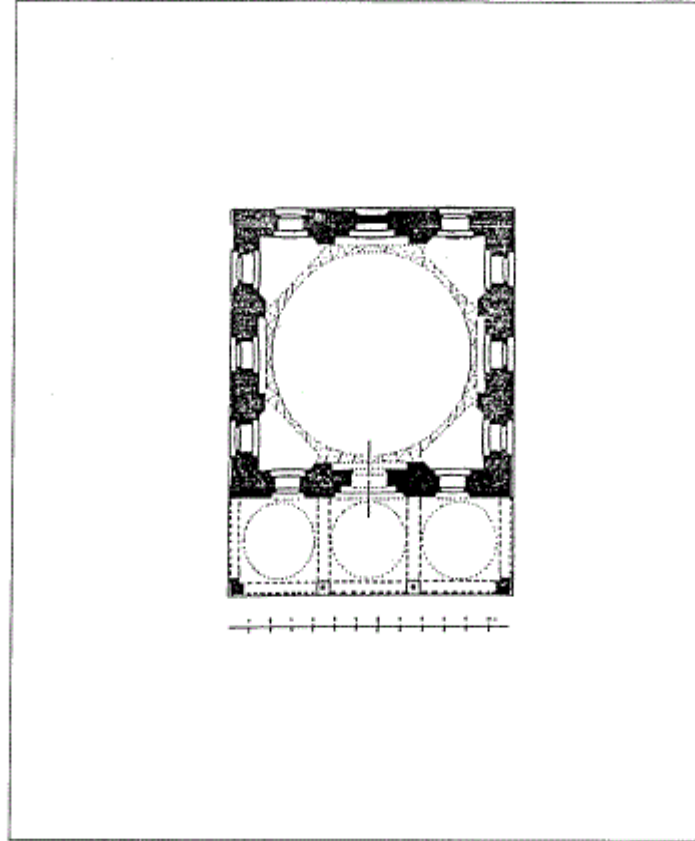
مسقط أفقي لمسجد الياس بك في كورتزه (عن : كيل) .
